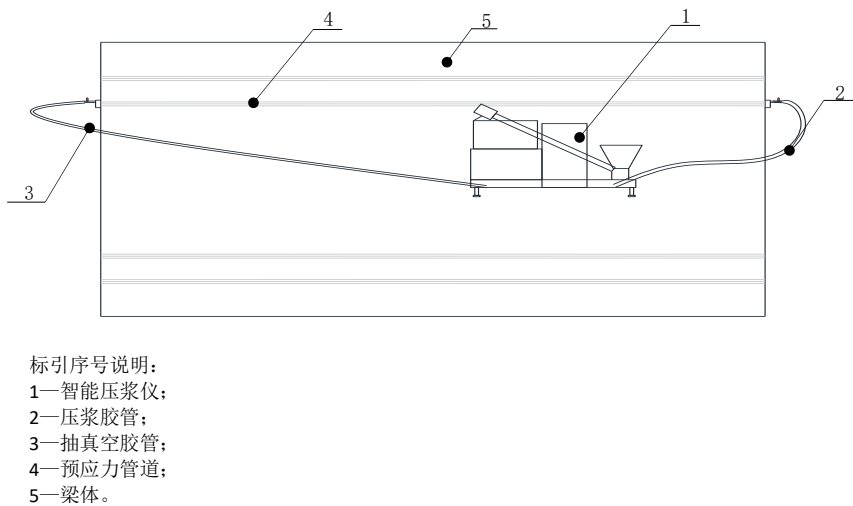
预应力混凝土现浇梁智能压浆设备连接示意图
